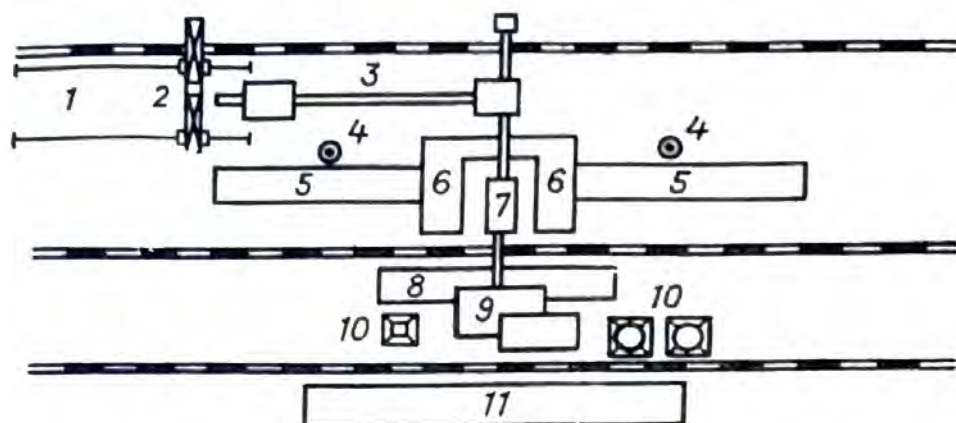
Типовая планировка и основные сооружения коксового цеха:
